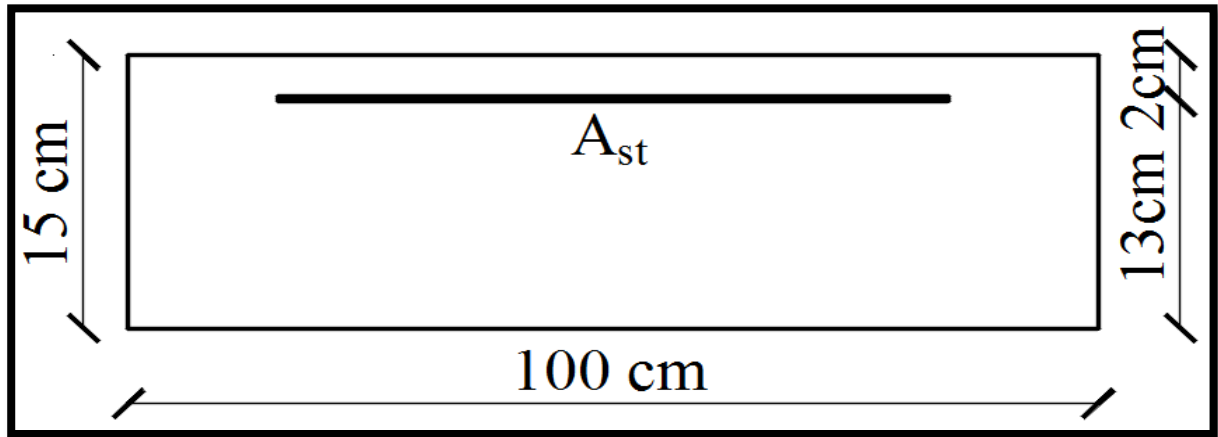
Schématization (2D) de la section transversale du porte-à-faux.
